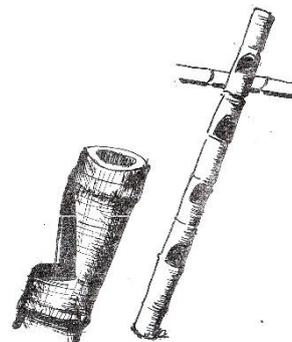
Escalera de caña y detalle escalón (pág.116)
